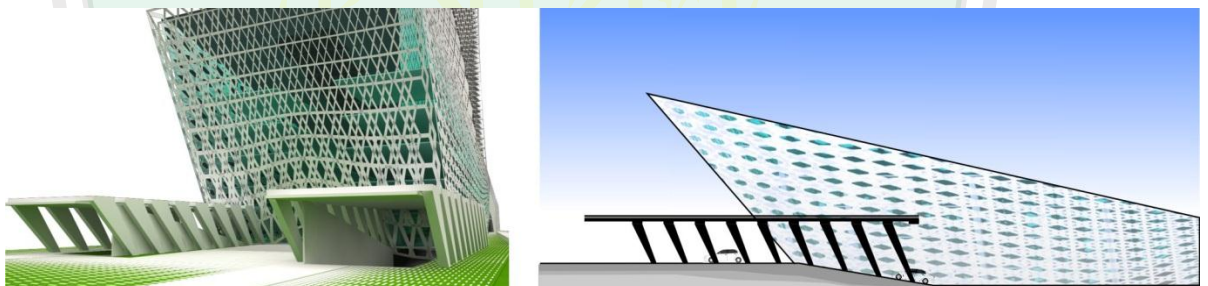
Detail Sirkulasi Kendaraan Kedalam Bassement
